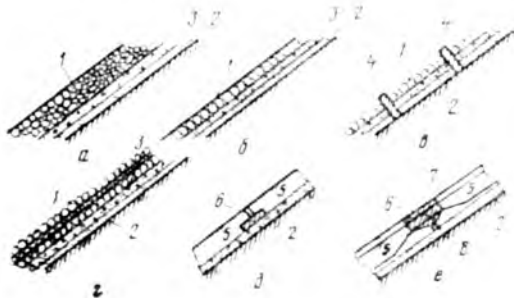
Типы крепления верхних откосов: а — каменная наброска; б, г — одиночная и двойная мостовая; в — мостовая в клетках; д, е — швы в монолитном и сборном железобетонном покрытиях; 1 — камень; 2, 3 — первый и второй слои подготовки; 4 — армированные бетонные балки; 5 — плита перекрытия; 6 — сварка арматуры; 7 — заволакивание бетоном; 8 — деревянная доска.
